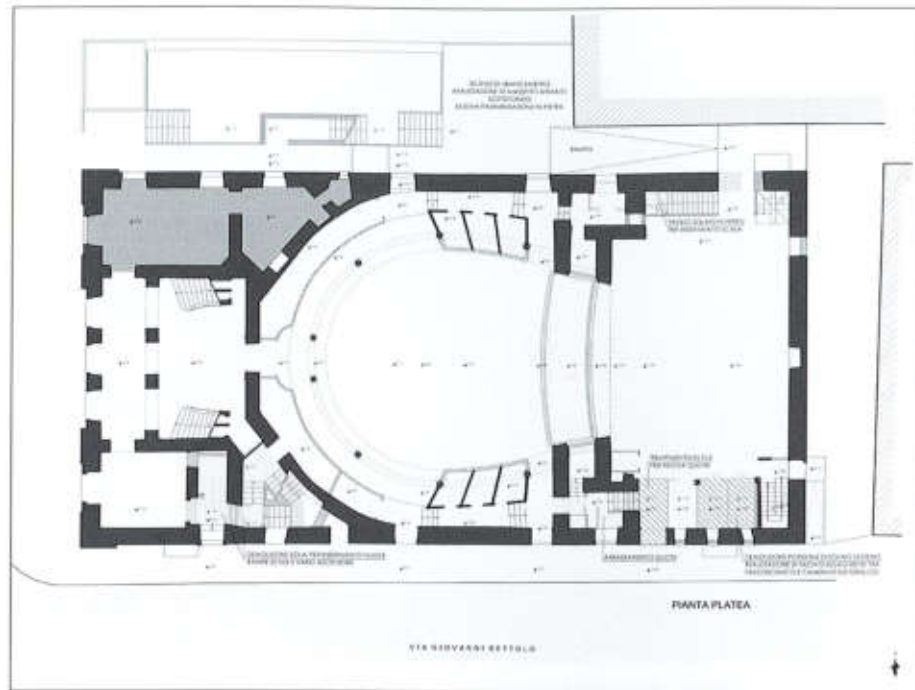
Pianta delle demolizioni e ricostruzioni del piano platea.
